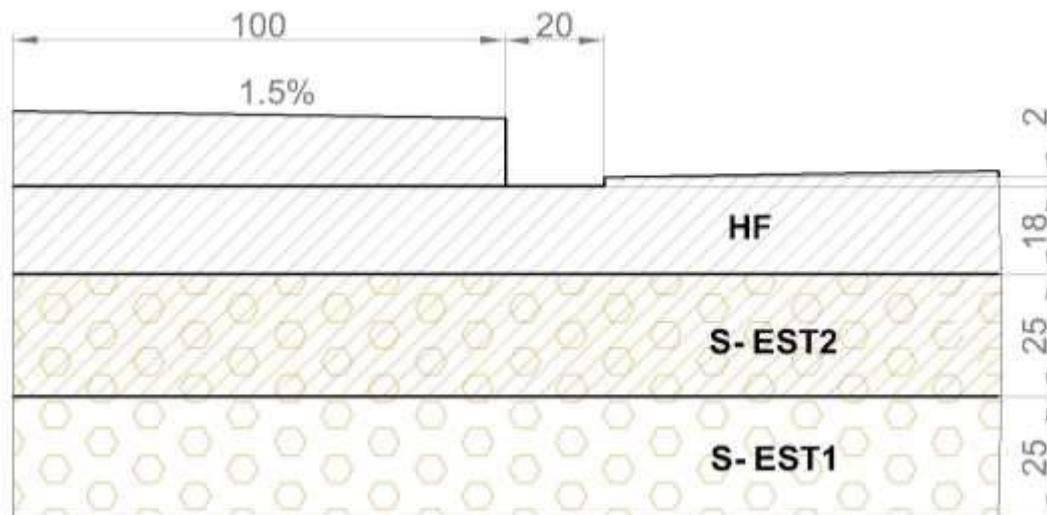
Detalle sección de aceras. Fuente: Proyecto de planta de tratamiento de Residuos de construcción y Demolición en Algemés (Valencia).
